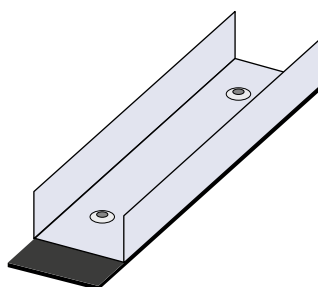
Aplicação de banda acústica entre o perfil raia e o suporte.
